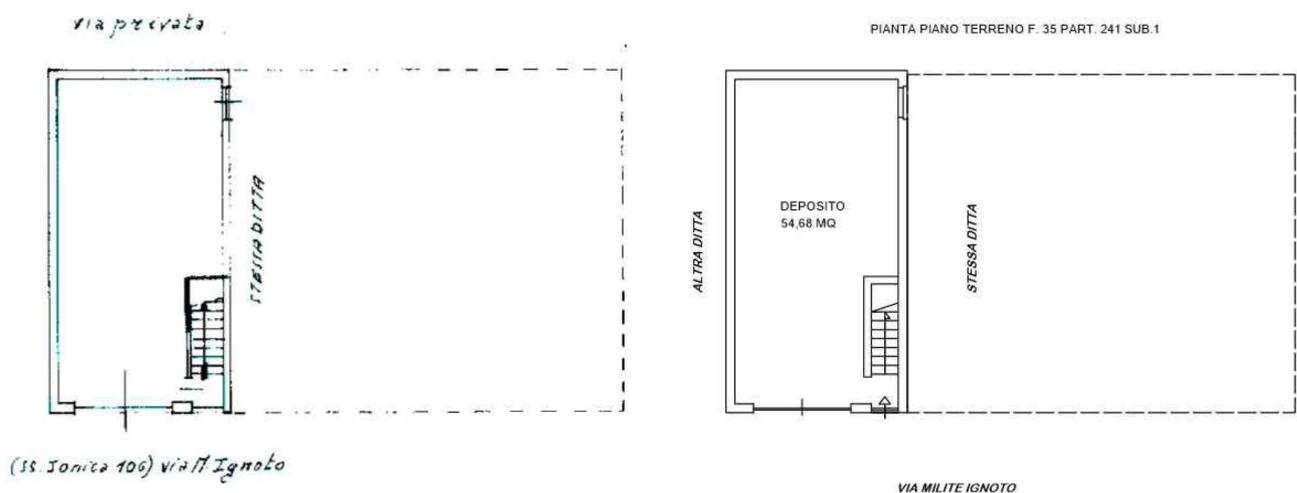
Planimetria catastale e stato di fatto del Piano Terreno
